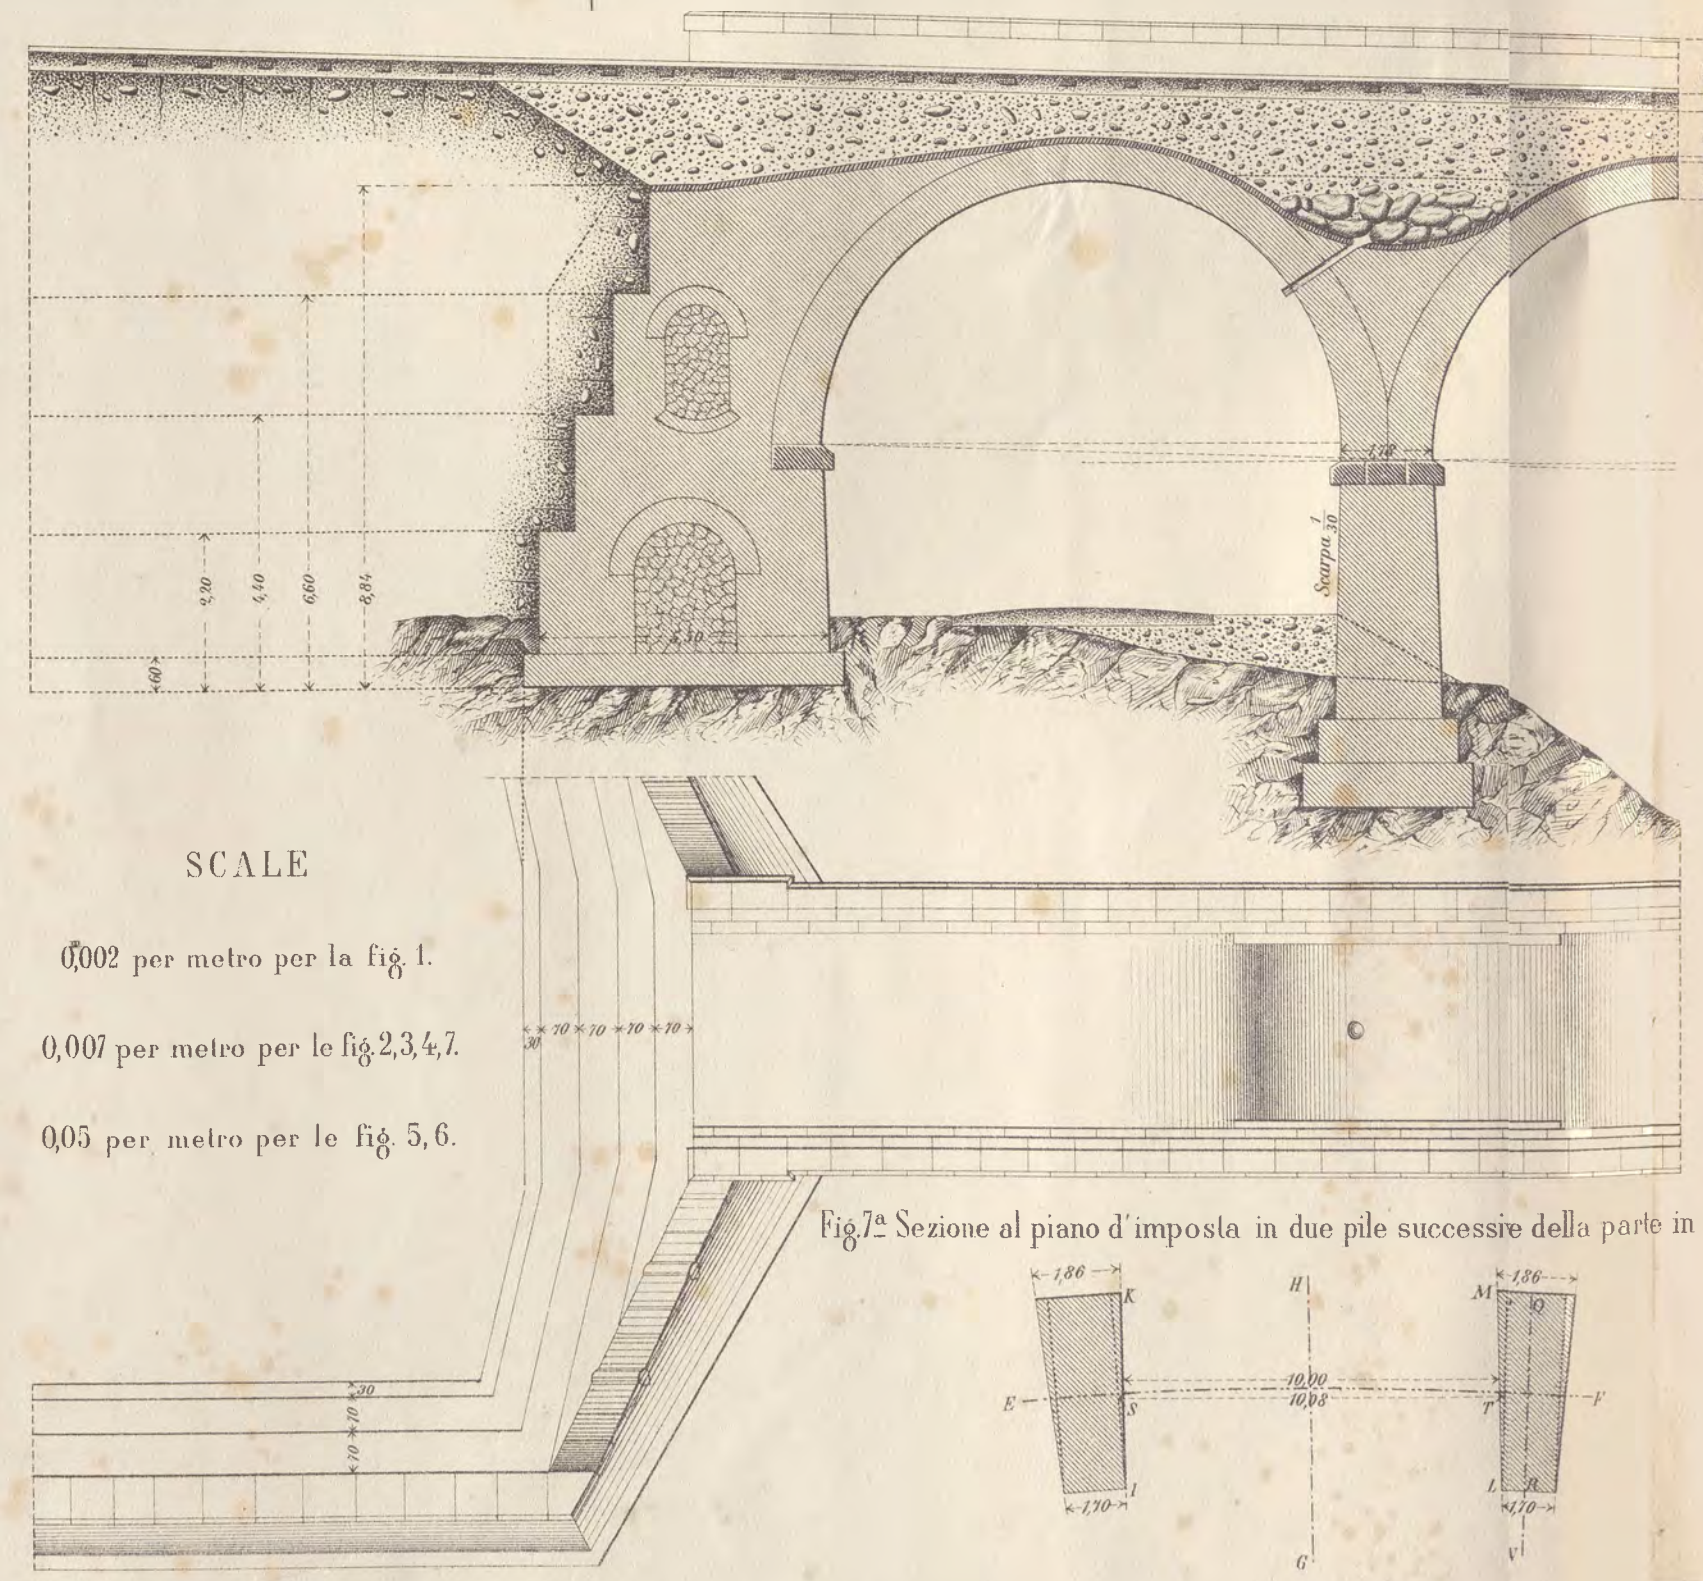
<sup>a</sup> Elevazione e pianta di un' estremità del Viadotto.
